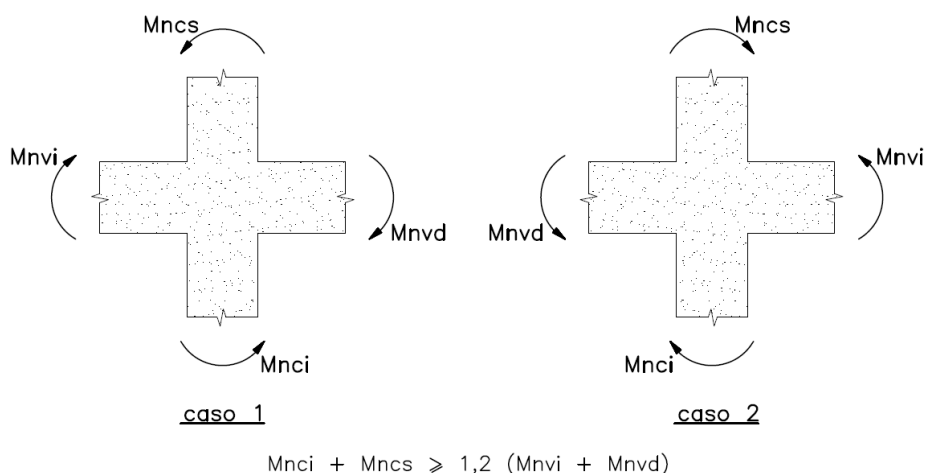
Resistencia a flexión de las columnas en las caras de los nudos
